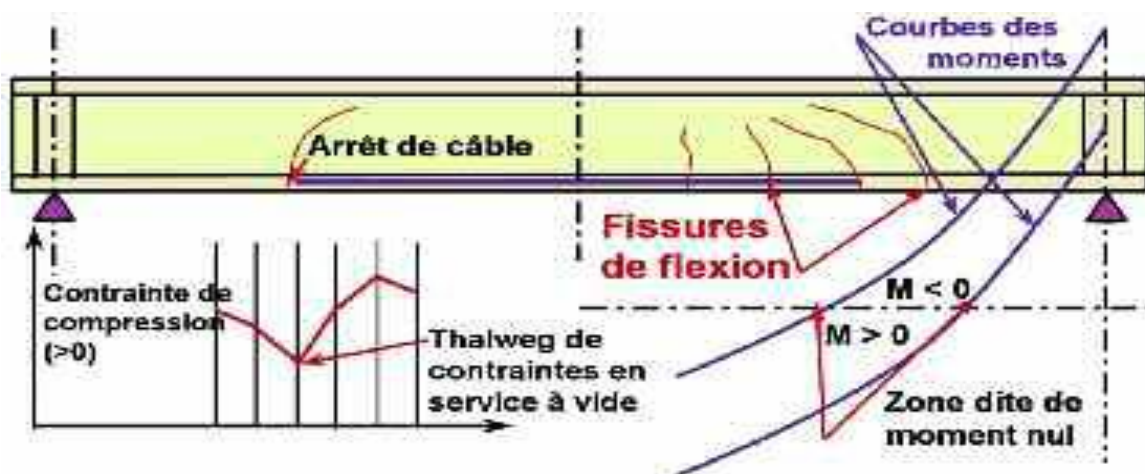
croquis des zones préférentielles de fissuration par flexion
